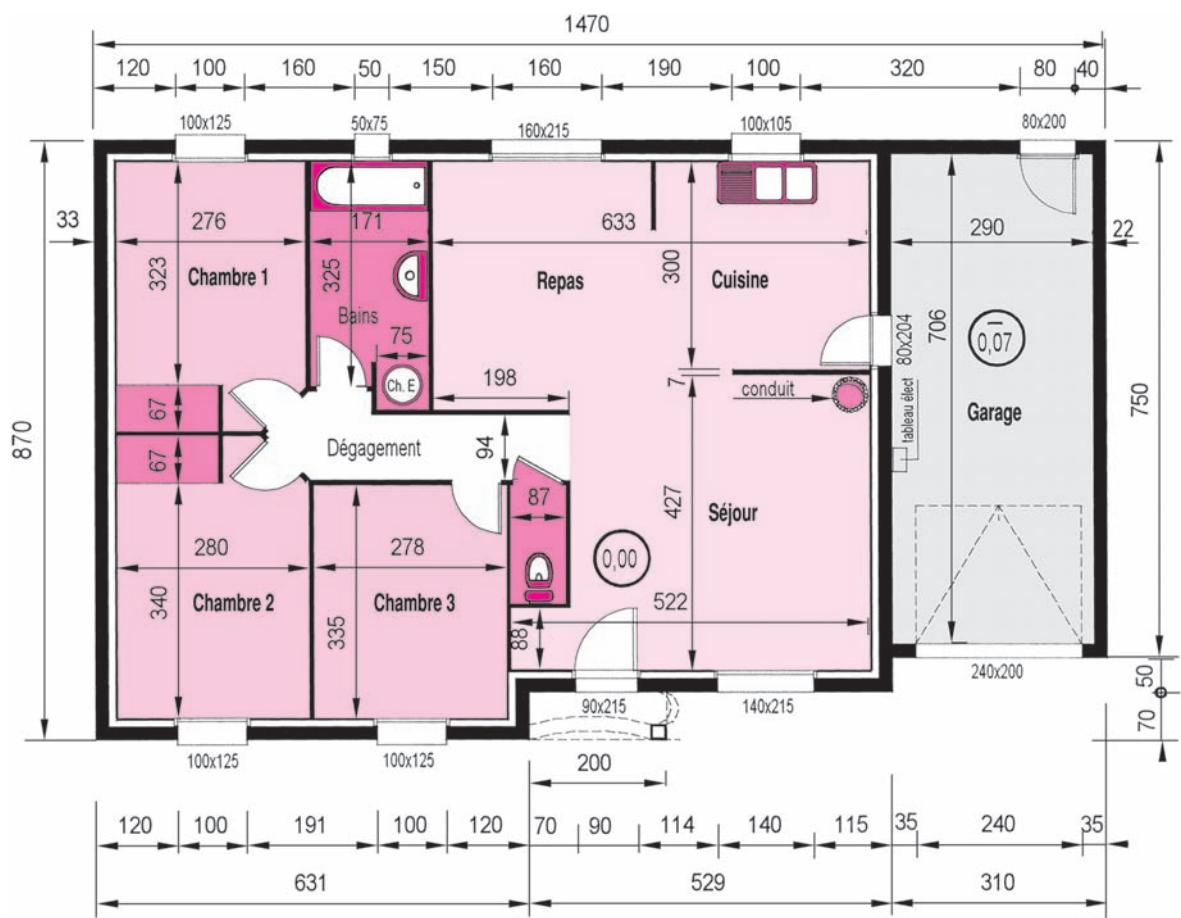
Plan du rez-de-chaussée avec l'emplacement des appareils sanitaires
